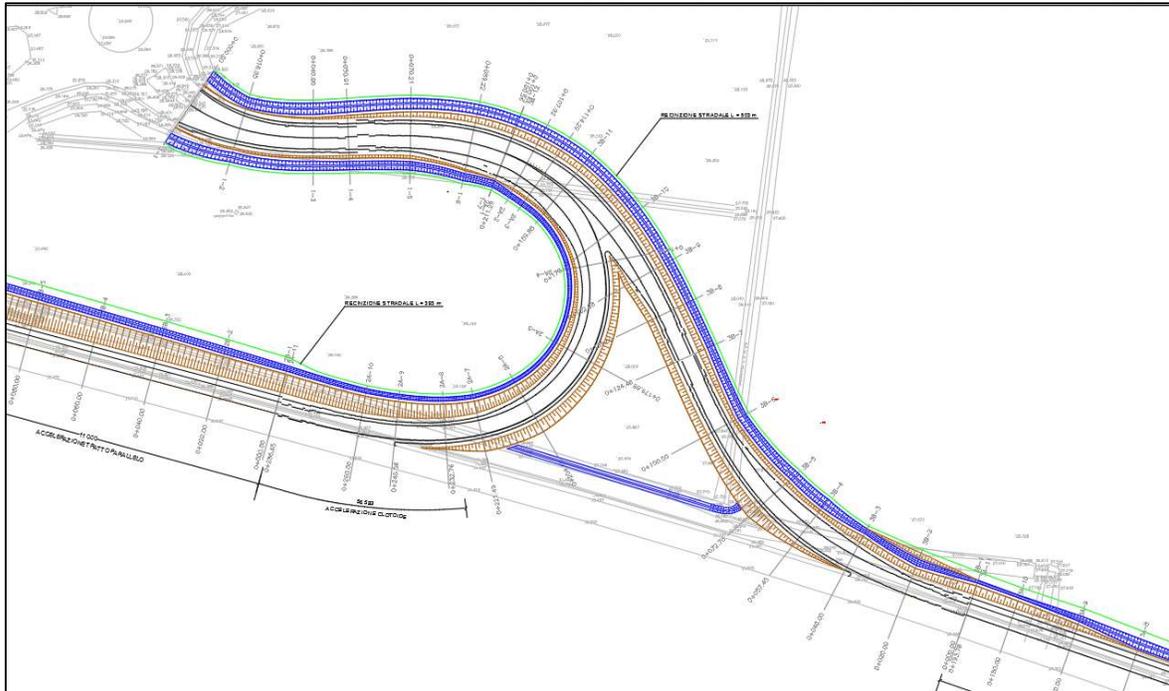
Estratto planimetria di progetto dello svincolo autostradale.
